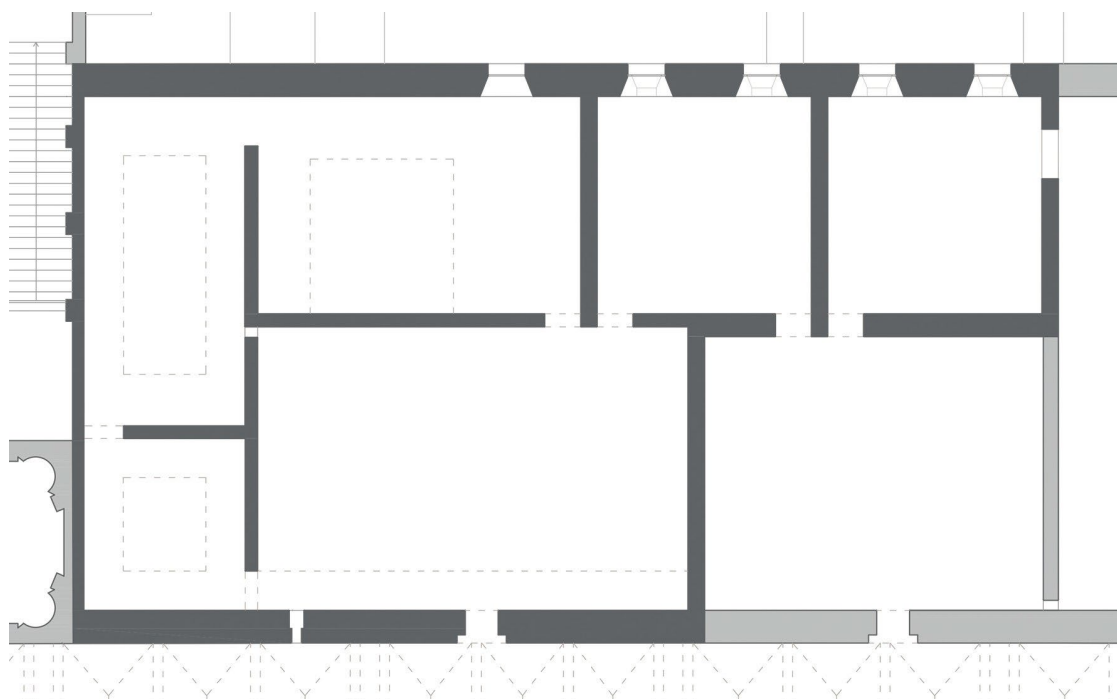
Planimetria del progetto realizzato dove si possono notare la posizione e la forma dei lucernai. Disegno di Ilaria Cattabriga.
